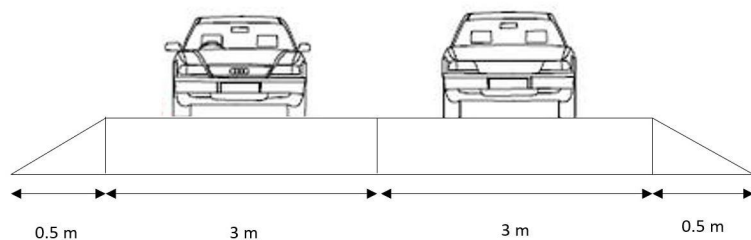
Sección transversal nueva. Fuente: Elaboración propia.
